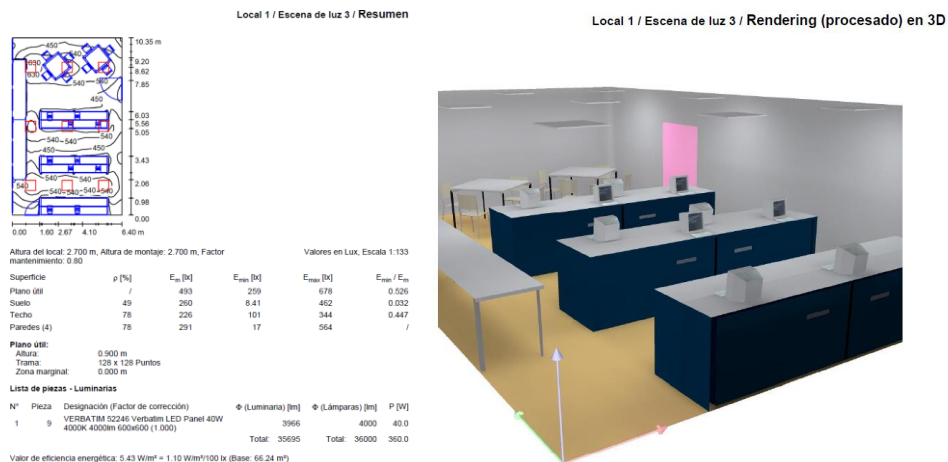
Diseño de iluminación propuesto para laboratorio en Planta 7.
